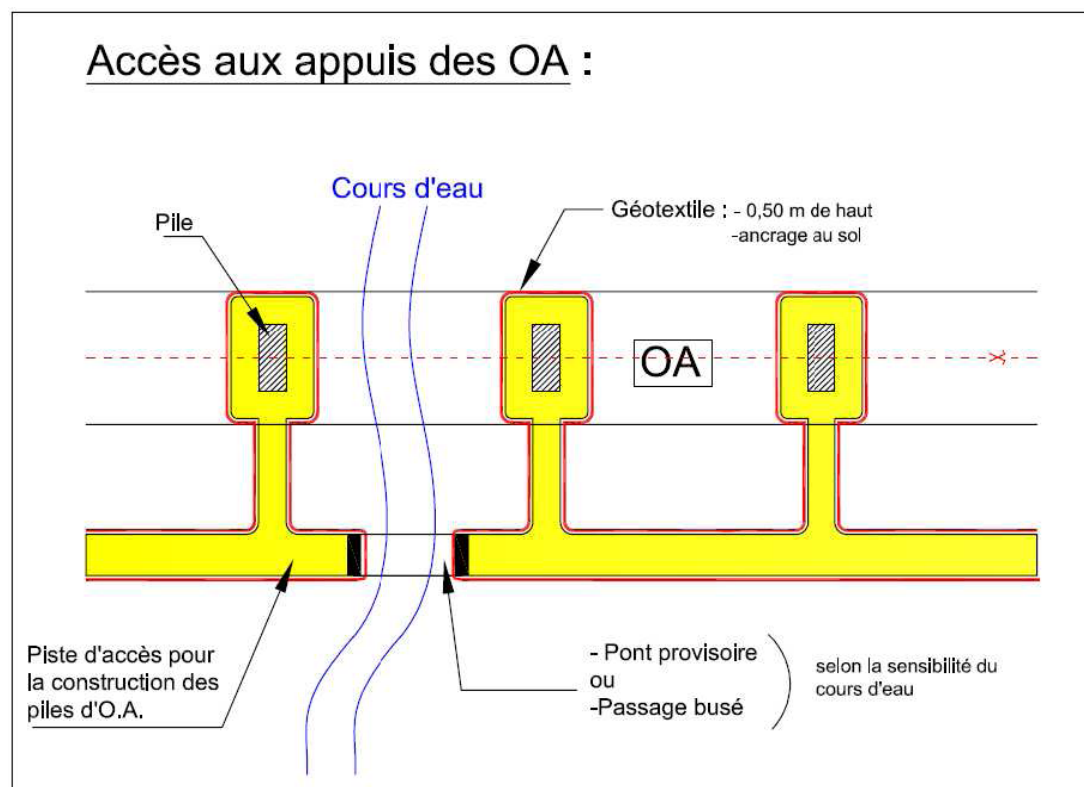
Schéma d'implantation de piste pour construction d'un ouvrage d'art
